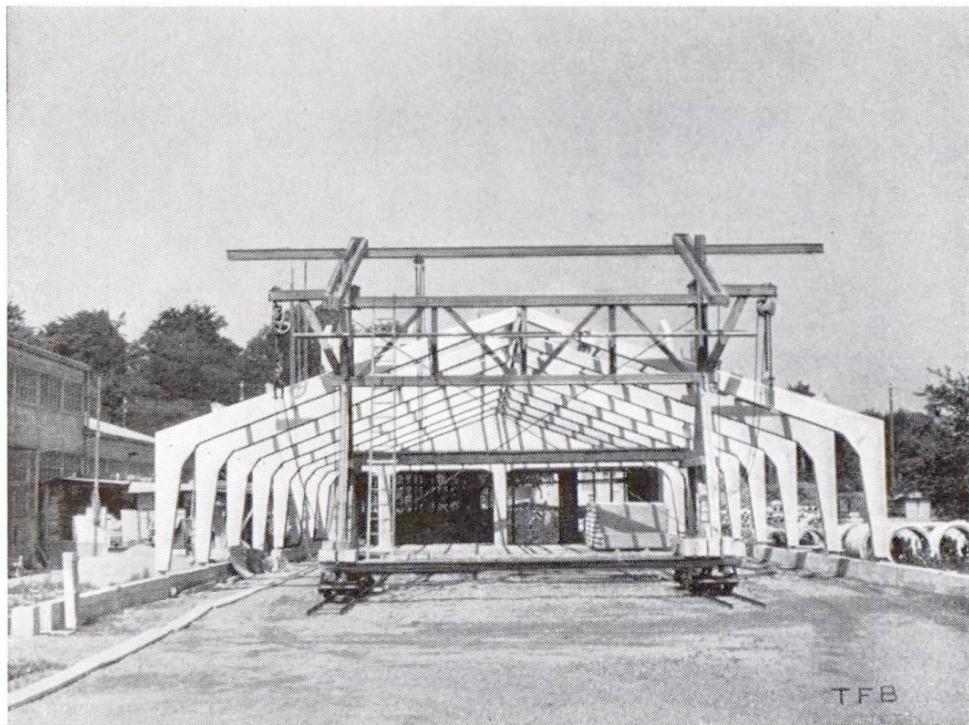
Montage des fermes en béton armé. Au premier plan, pont roulant de montage
